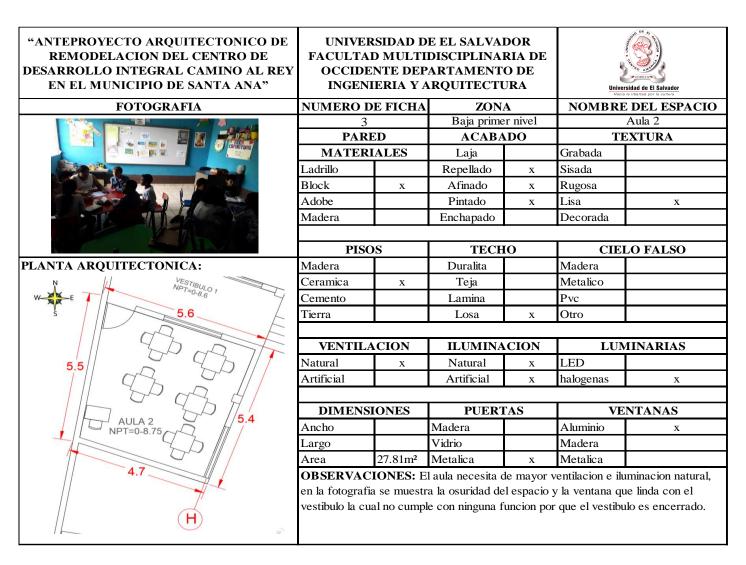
Planta arquitectónica baja primer nivel. Elaboración propia.
